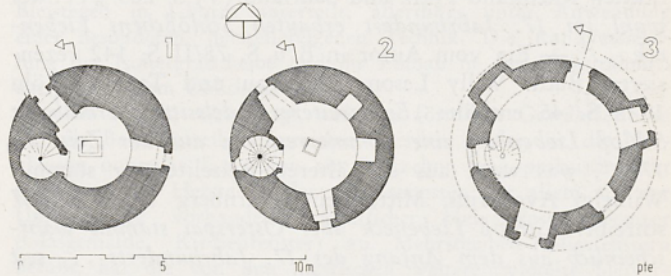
Schloß Waldmannshofen, Grundrisse des Großen Turmes (Bauaufnahme Pfefferkorn)
